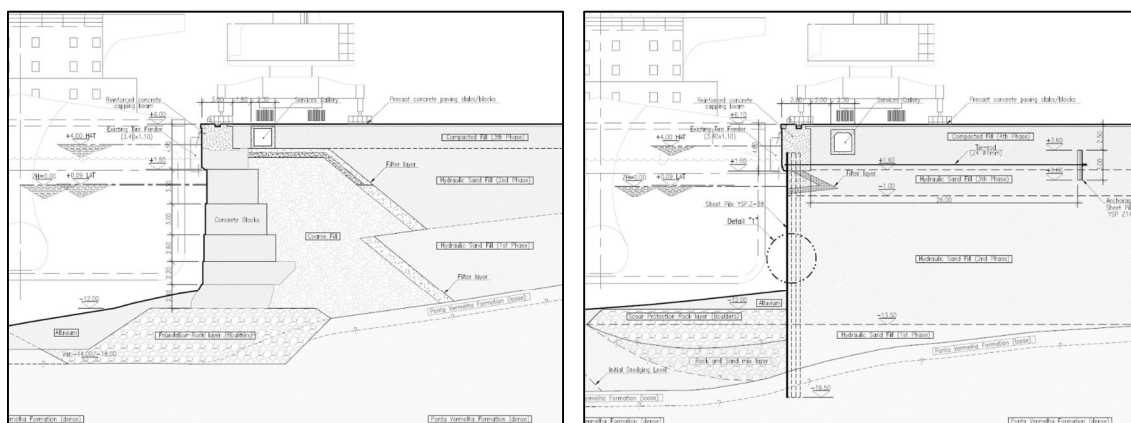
Estrutura existente: Cais tipo “J” e “L” respetivamente
